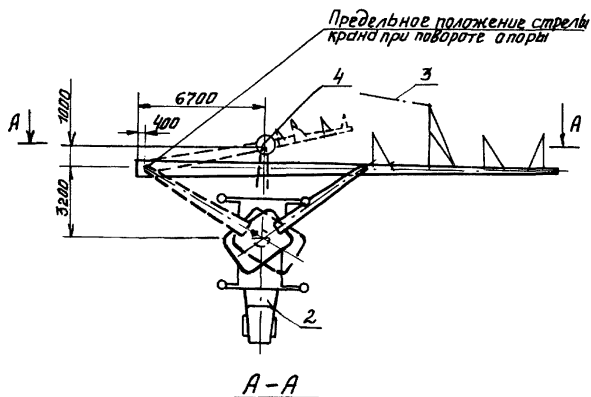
Схема подъема опоры: ПУБ 35-110-1 краном К-162, 1-стойка; 2-кран; 3-веревочные расчалки; 4-цилиндрический котлован.
